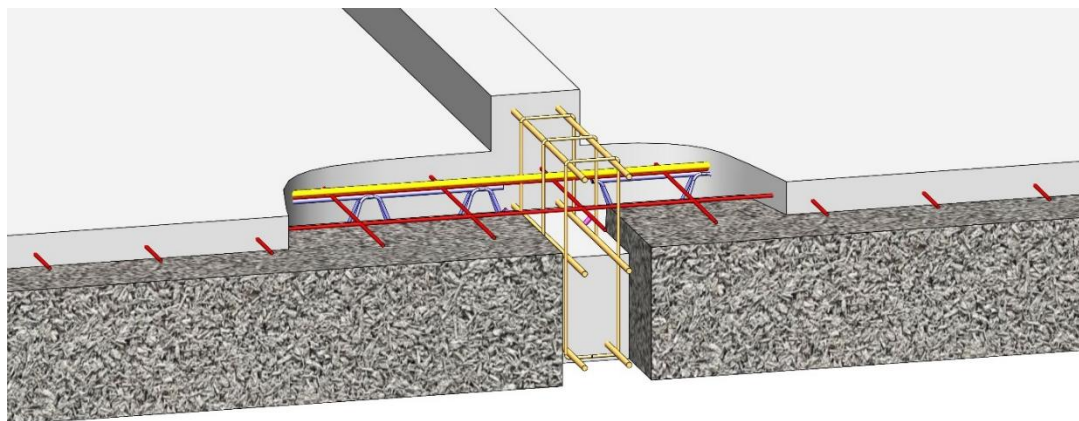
Illustration du liaisonnement avec différents types de poutres porteuses
